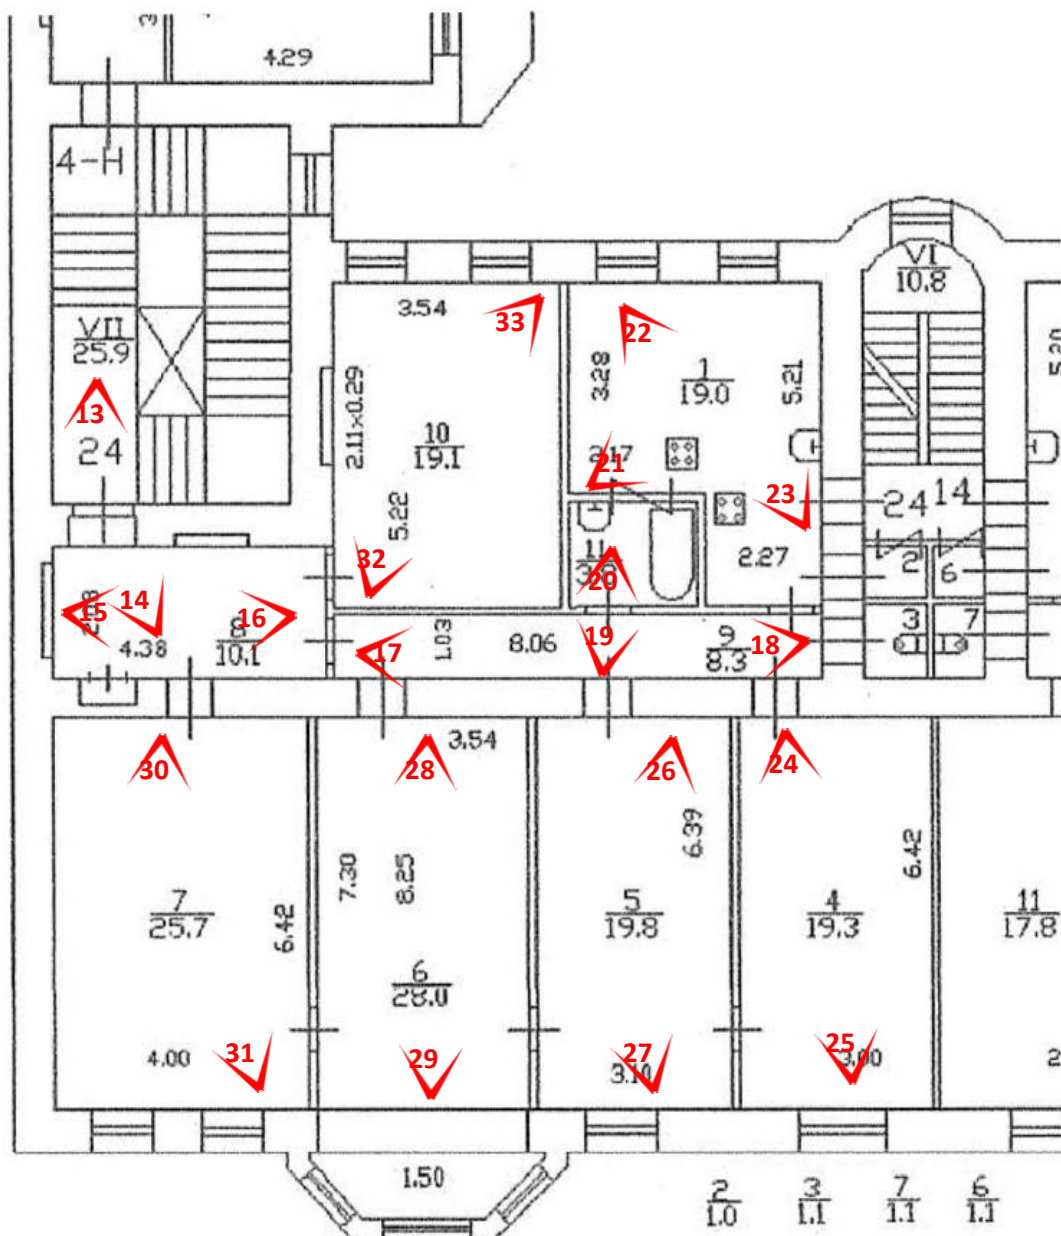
Схема фотофиксации на фрагменте плана 6 этажа
